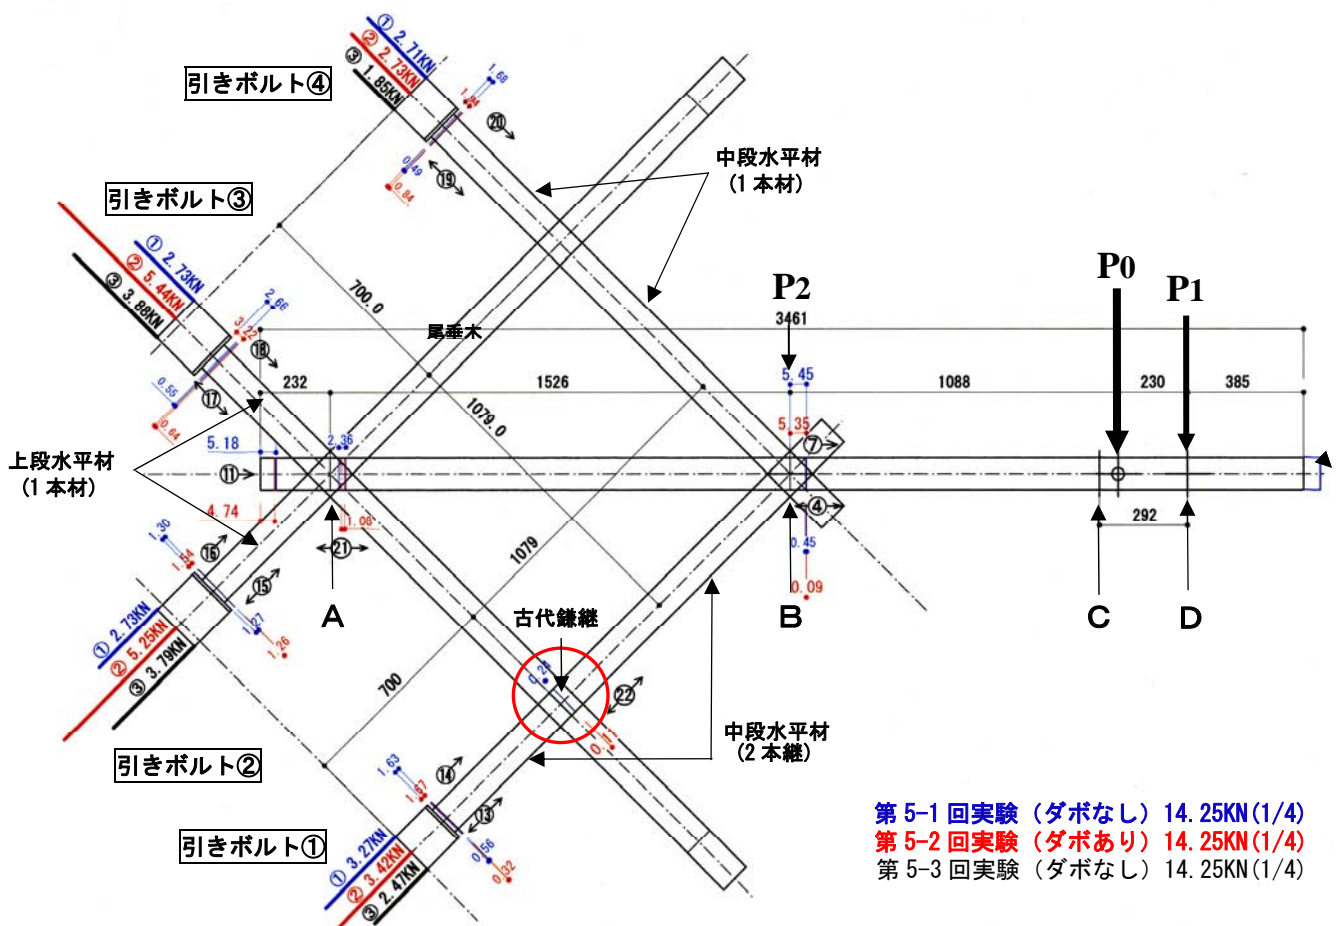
引ボルト張力図 第 5-1 回～第 5-3 回実験平面図
